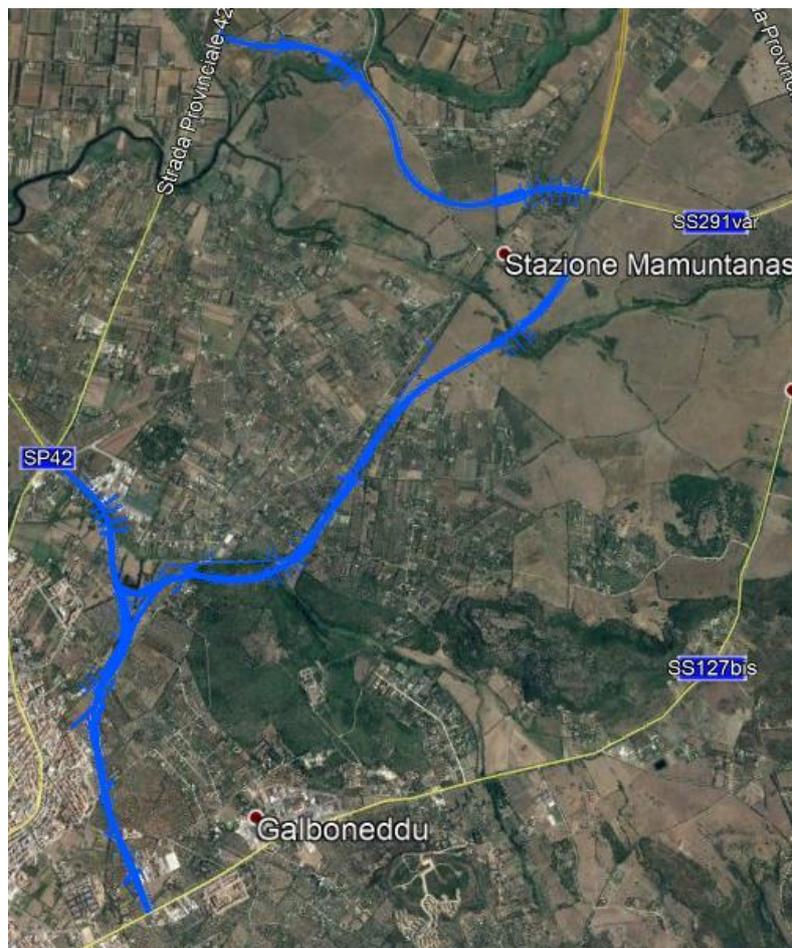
Localizzazione del tracciato di progetto su ortofoto
